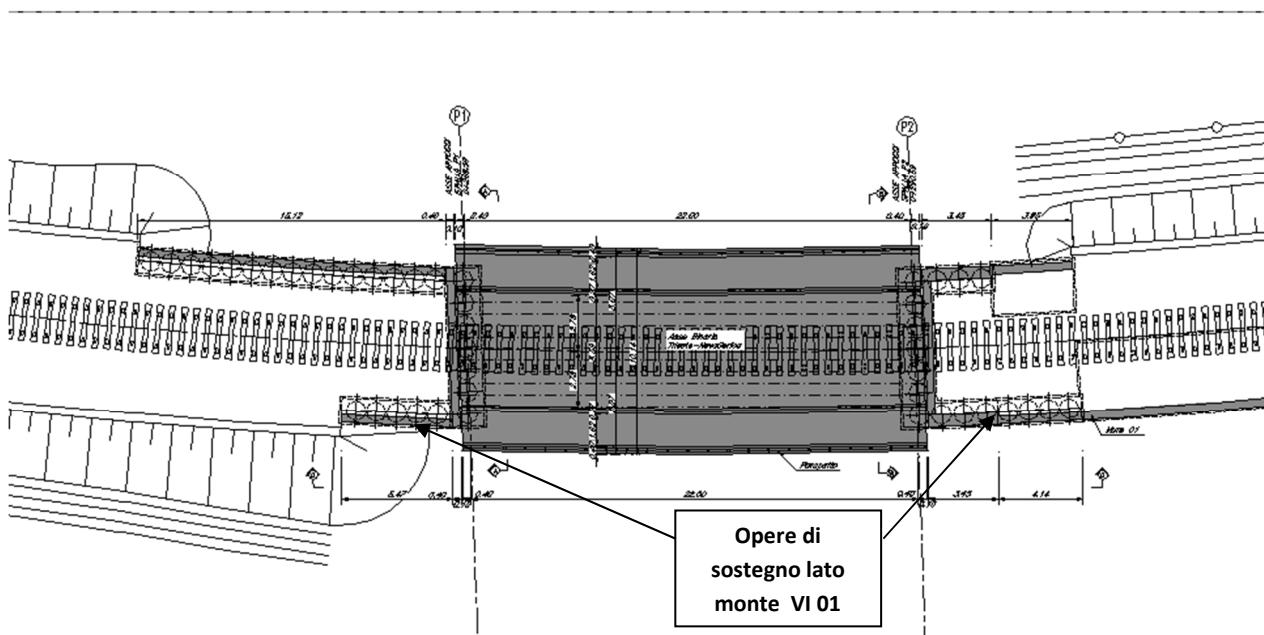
Planimetria con ubicazione dell'opera di sostegno lato monte.
